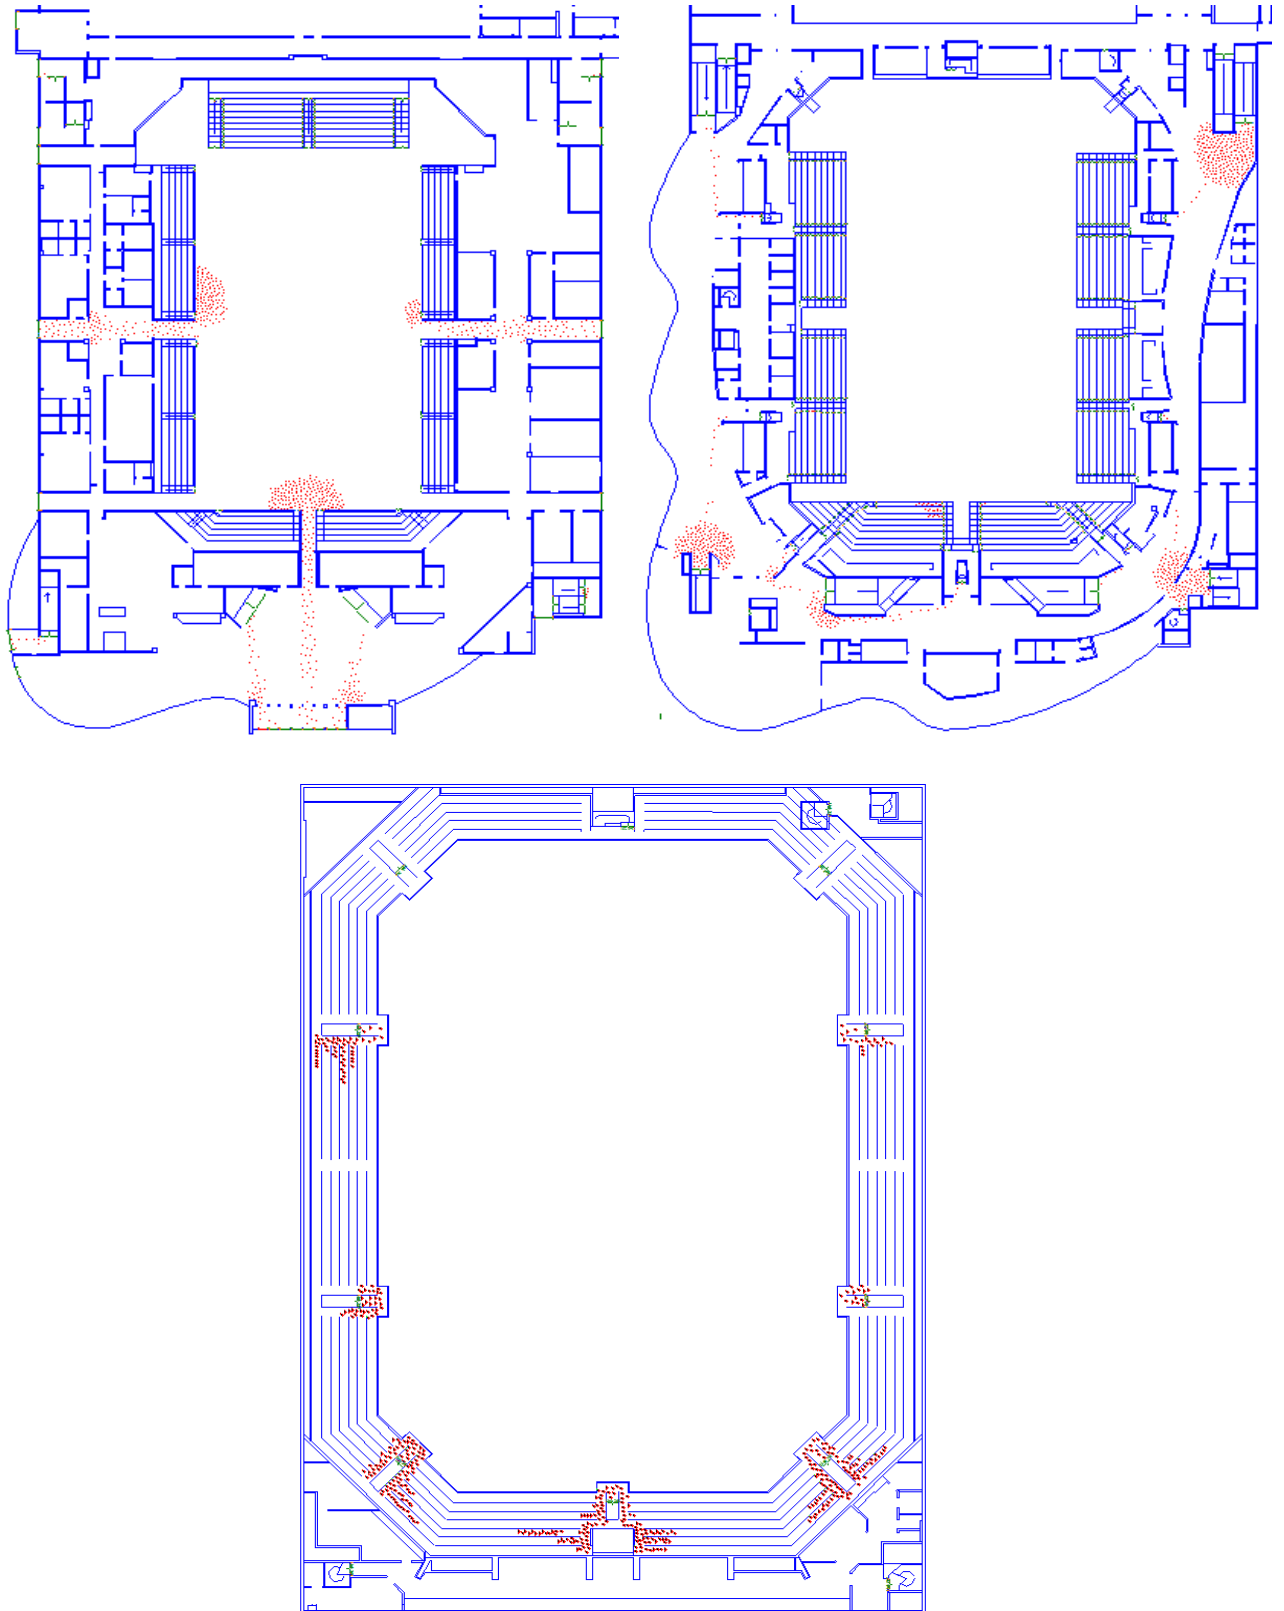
Simuleringens utseende 120 sekunder efter påbörjad utrymning. Plan 1 uppe till höger, plan 2 uppe till vänster och plan 3 nedre bilden.
